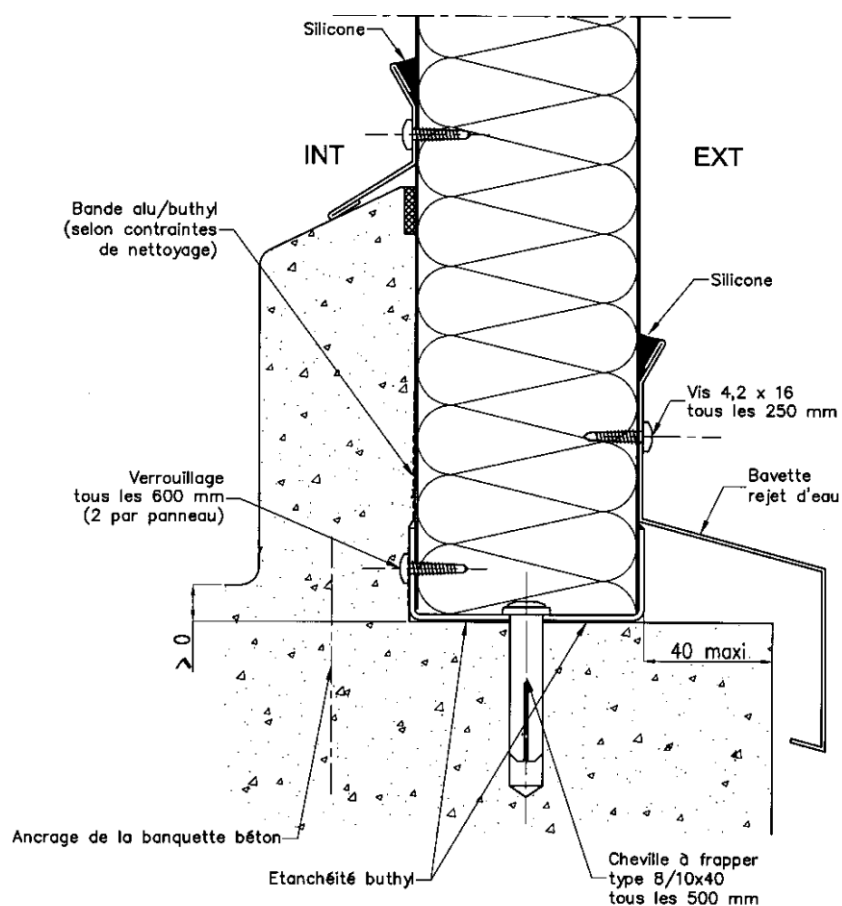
Schéma 4 – Panneaux liaison au sol – Banquette béton / Bavette jet d'eau
